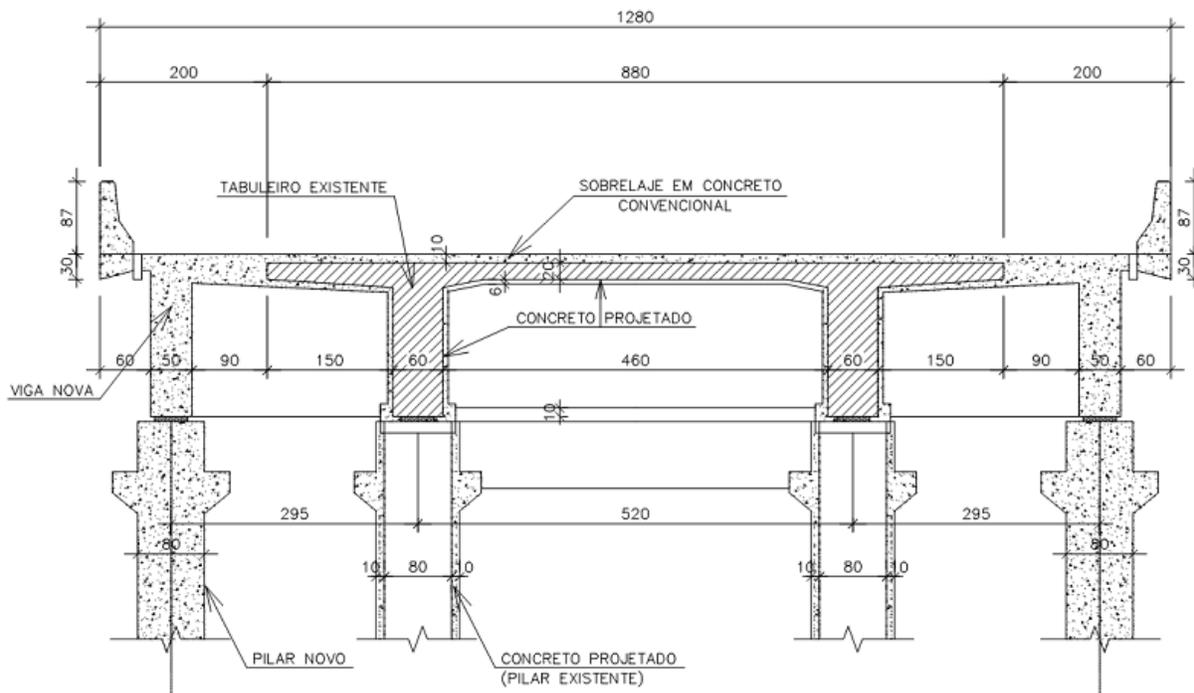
Seção transversal após alargamento com concreto armado convencional, com a adição de novos pilares (VITÓRIO. (2013)).
